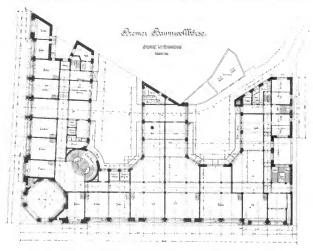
Grundrifs des Erdgeschosses der Baumwollbörse. J. Poppe. 1899.
